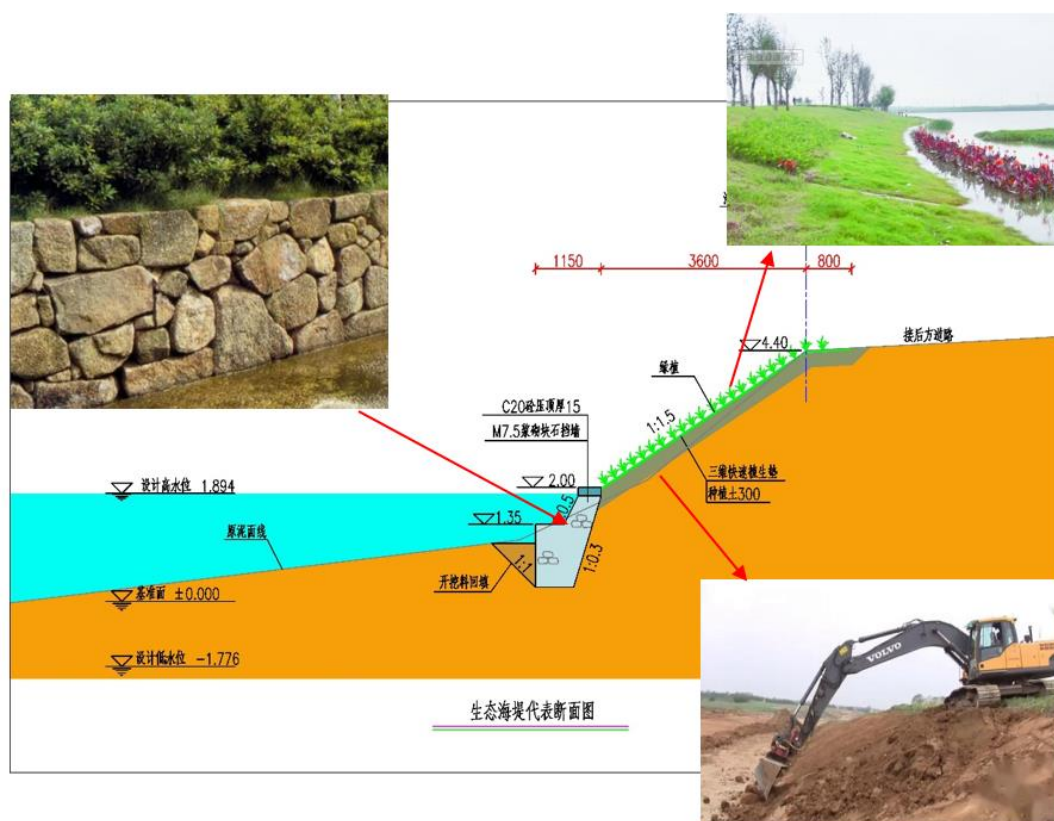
葫芦岛经济开发区综合产业园区生态海堤建设施工方法示意图
